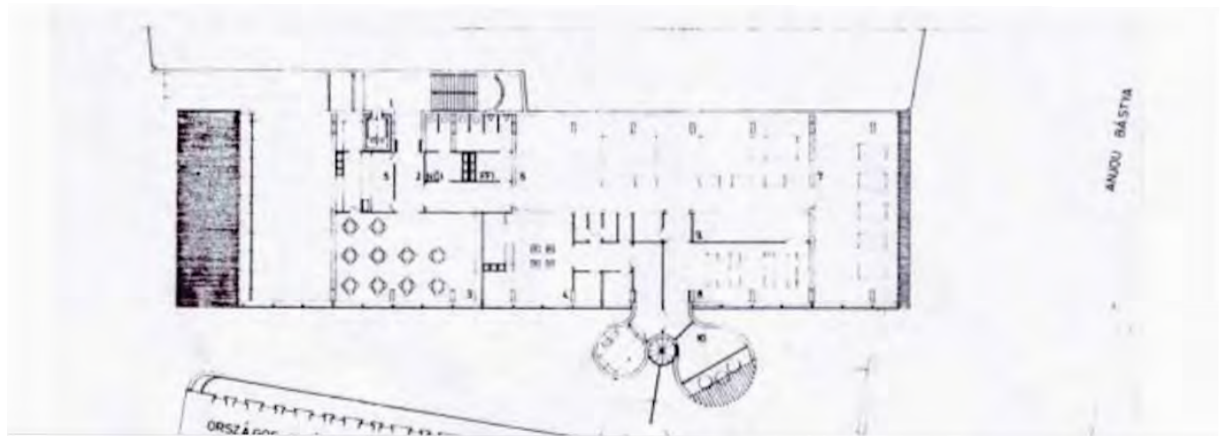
Transformatorhaus Grundriss Obergeschoss
